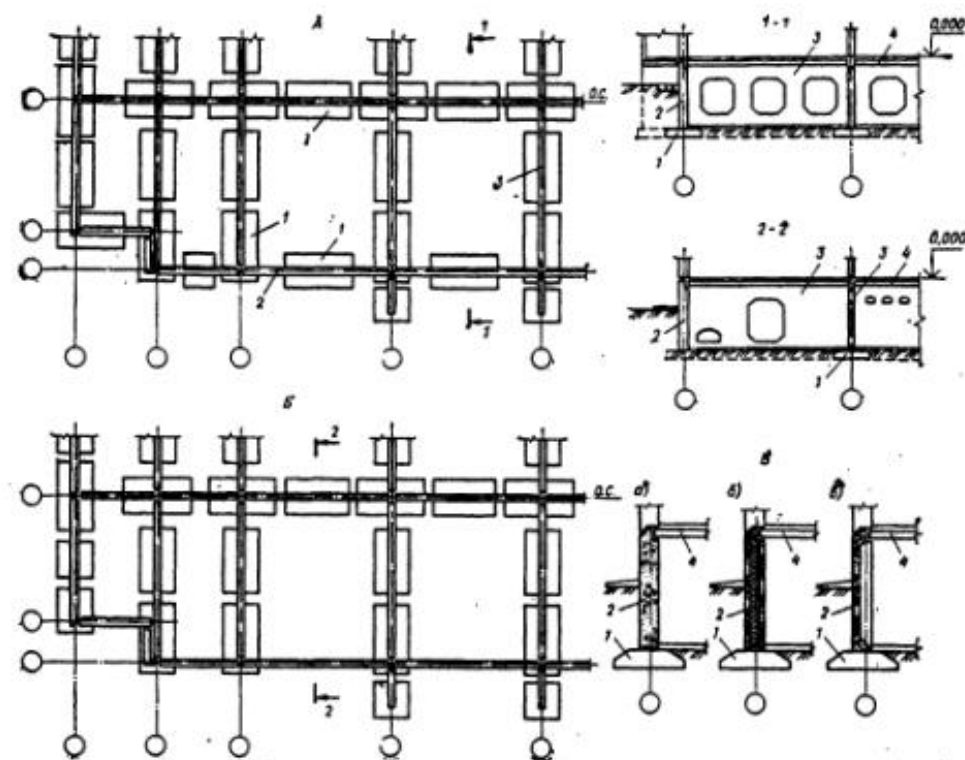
Сборные ленточные фундаменты панельных зданий с поперечными внутренними несущими стенами: А - фундамент плана при несущих продольных наружных стенах; Б - то же, при несущих; В - варианты конструкции наружных цокольных панелей; а - легкогобетонных; б - трехслойных; в - ребристых железобетонных; 1 - железобетонная фундаментная подушка; 2 - наружная цокольная панель; 3 - цокольная внутренняя панель; 4 - цокольное перекрытие
